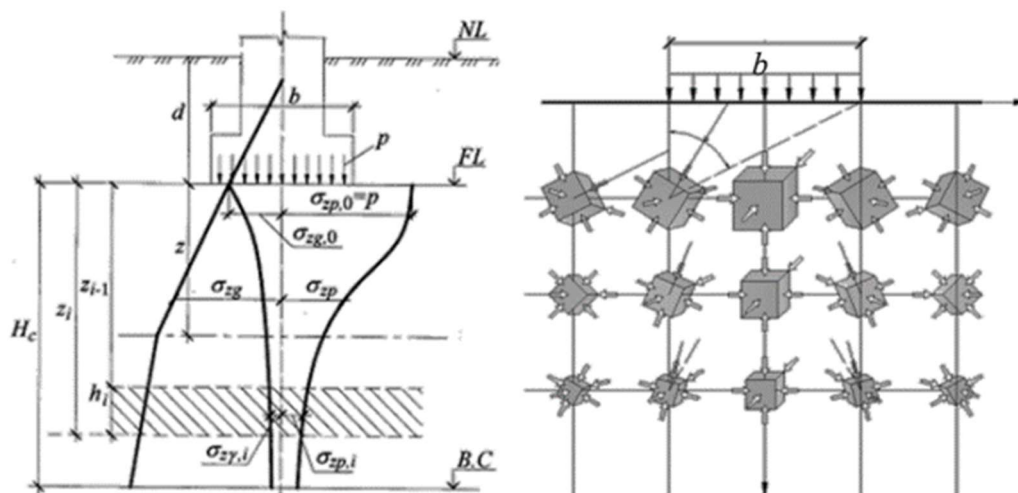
Расчетная схема к определению осадки фундамента при режимном нагружении (иллюстрация авторов)
